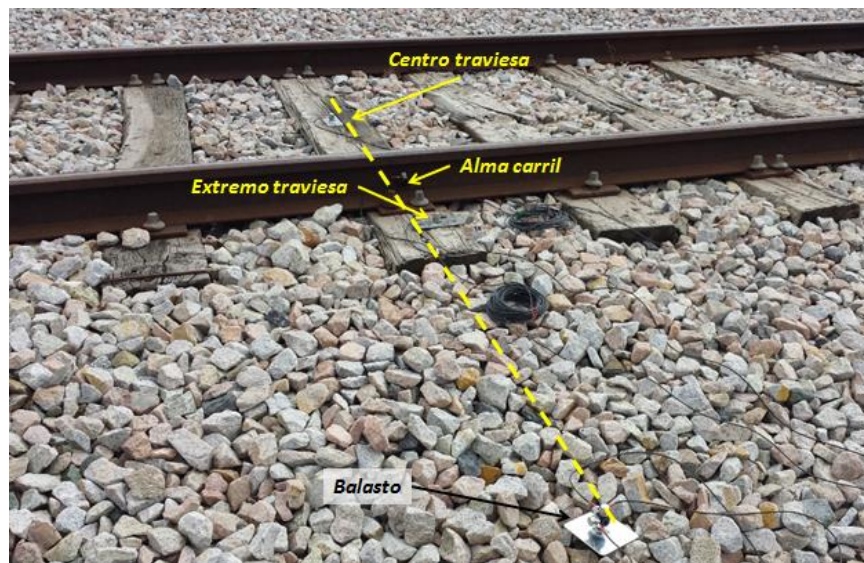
Ubicación de 4 puntos de medición: Centro traviesa, alma carril, extremo traviesa y balasto. Fuente: Elaboración propia
